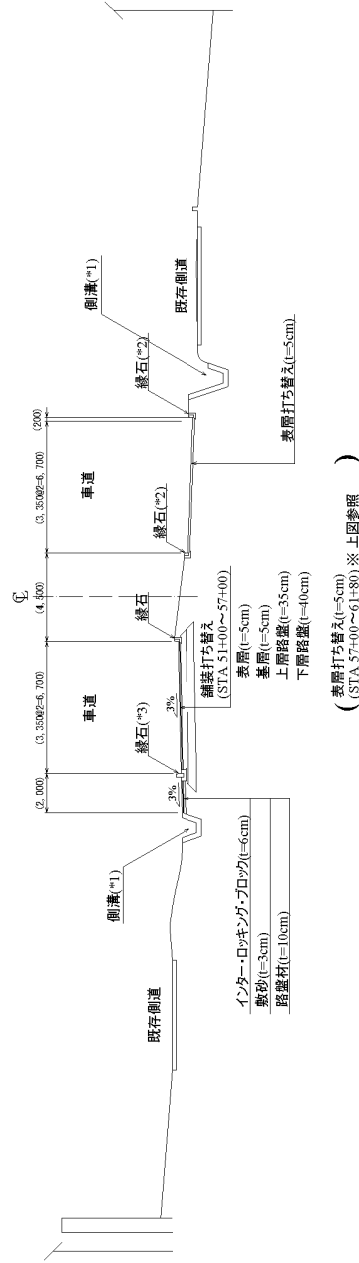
区間-3 (マセレマ RA~ヤナキス RA 区間) 標準断面図
